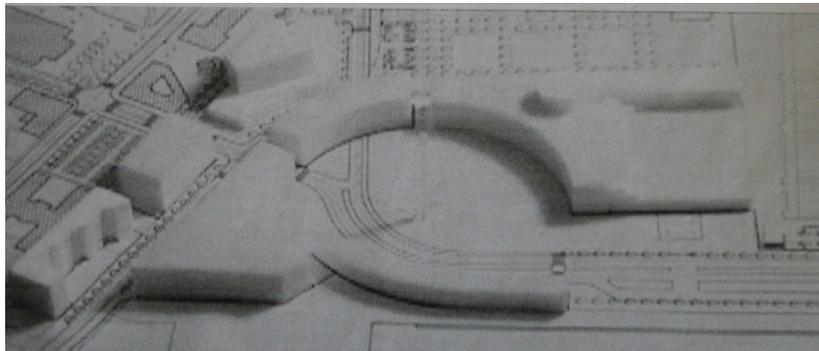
Progetto urbanistico e di massima del Porto di santa Teresa, O. Bohigas, seconda versione, 1998; particolare modello e planimetria generale di progetto
